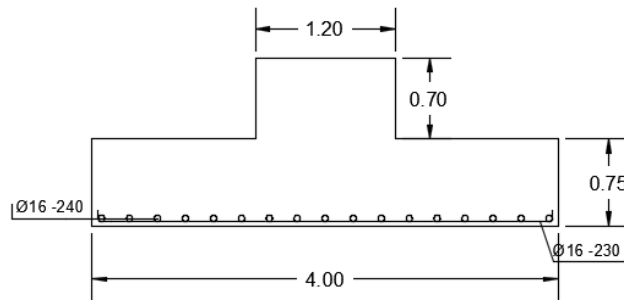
ferrailage de la semelle sous poteau de rive avec palée de stabilité en V
